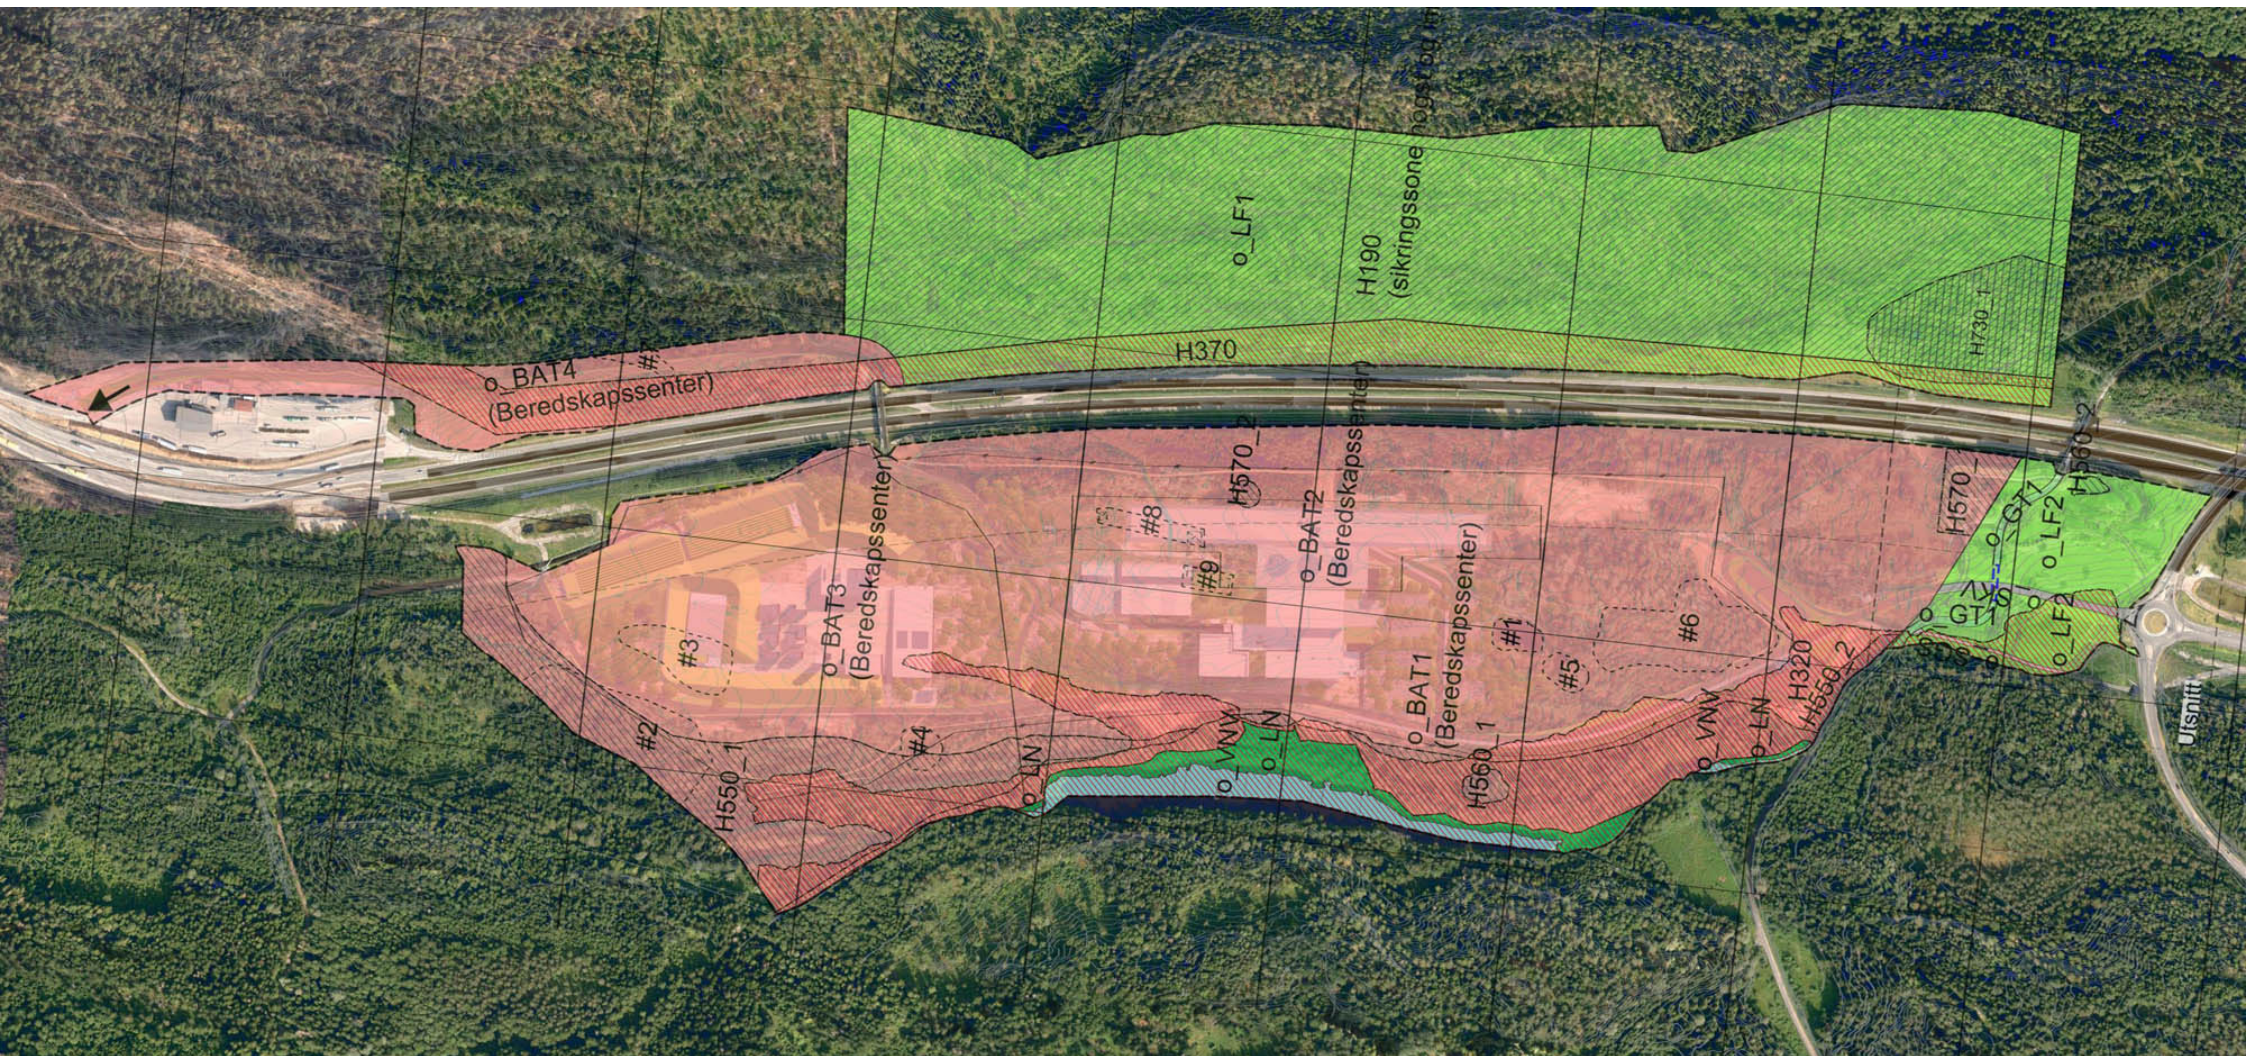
Plan som illustrerer anlegget lagt inn på ortofoto. (Nord er til venstre på figuren).
